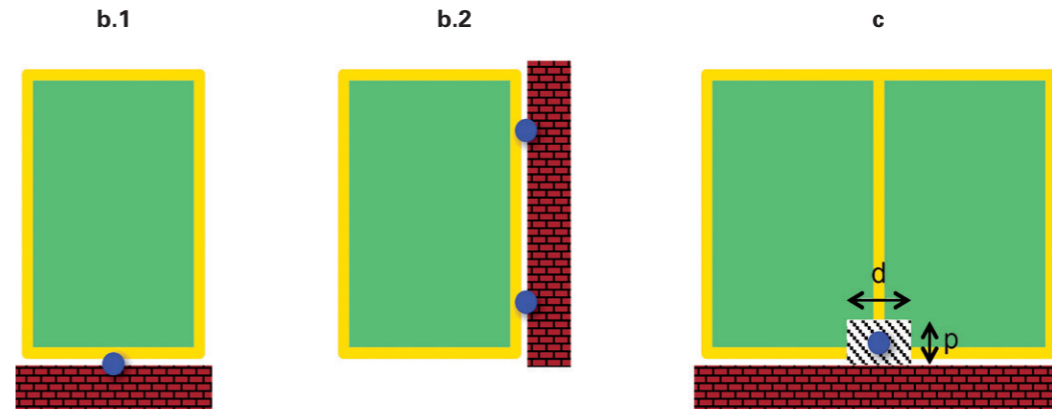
Mögliche Installationspunkte der Ladestation (mit blauen Kreisen gekennzeichnet) bei Flottenparkplätzen. Fälle b.1 und b.2 beziehen sich auf Wall Box-Ladestationen, während sich Fall c sich auf Säule-Ladestationen bezieht (Fälle an denen eine Wandinstallation nicht möglich ist).
